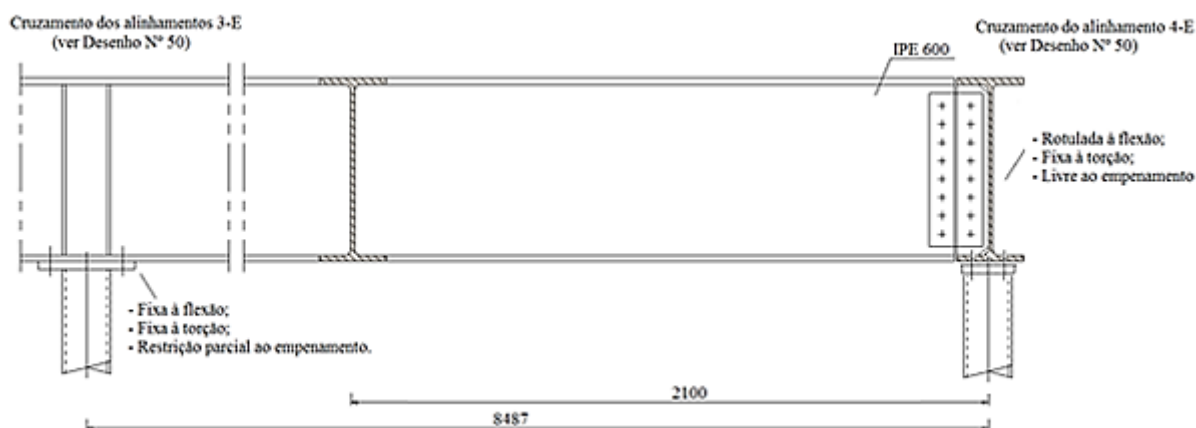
Representação das diferentes ligações da viga de bordo e respectivas condições de suporte: ligação viga-pilar situada no cruzamento dos alinhamentos 3-E; ligação viga-viga situada no cruzamento dos alinhamentos 4-E
